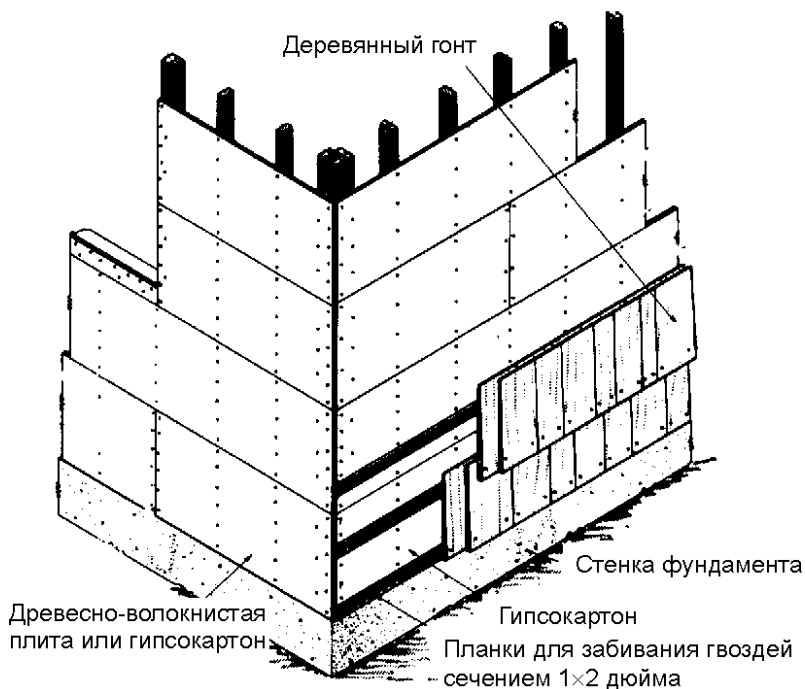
Планки для забивания гвоздей крепятся к стойкам поверх обшивки. После этого к ним прибиваются плитки гонта. По меньшей мере два гвоздя используются для крепления каждой плитки гонта
